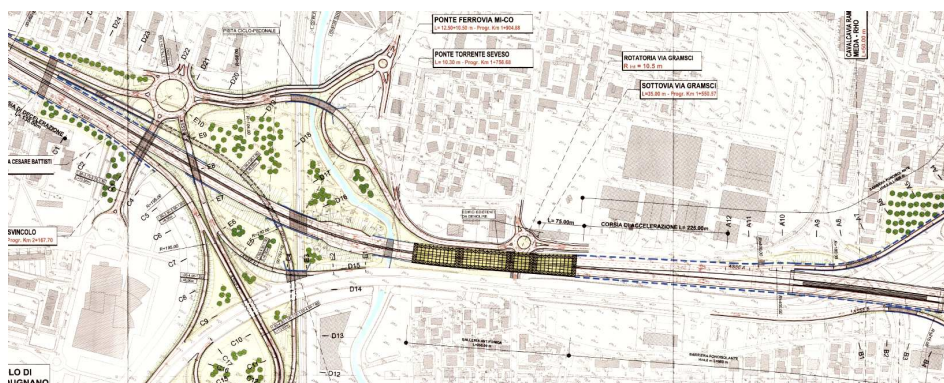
rendering di giacitura e galleria fonica (progetto MilanoSerravalle)
